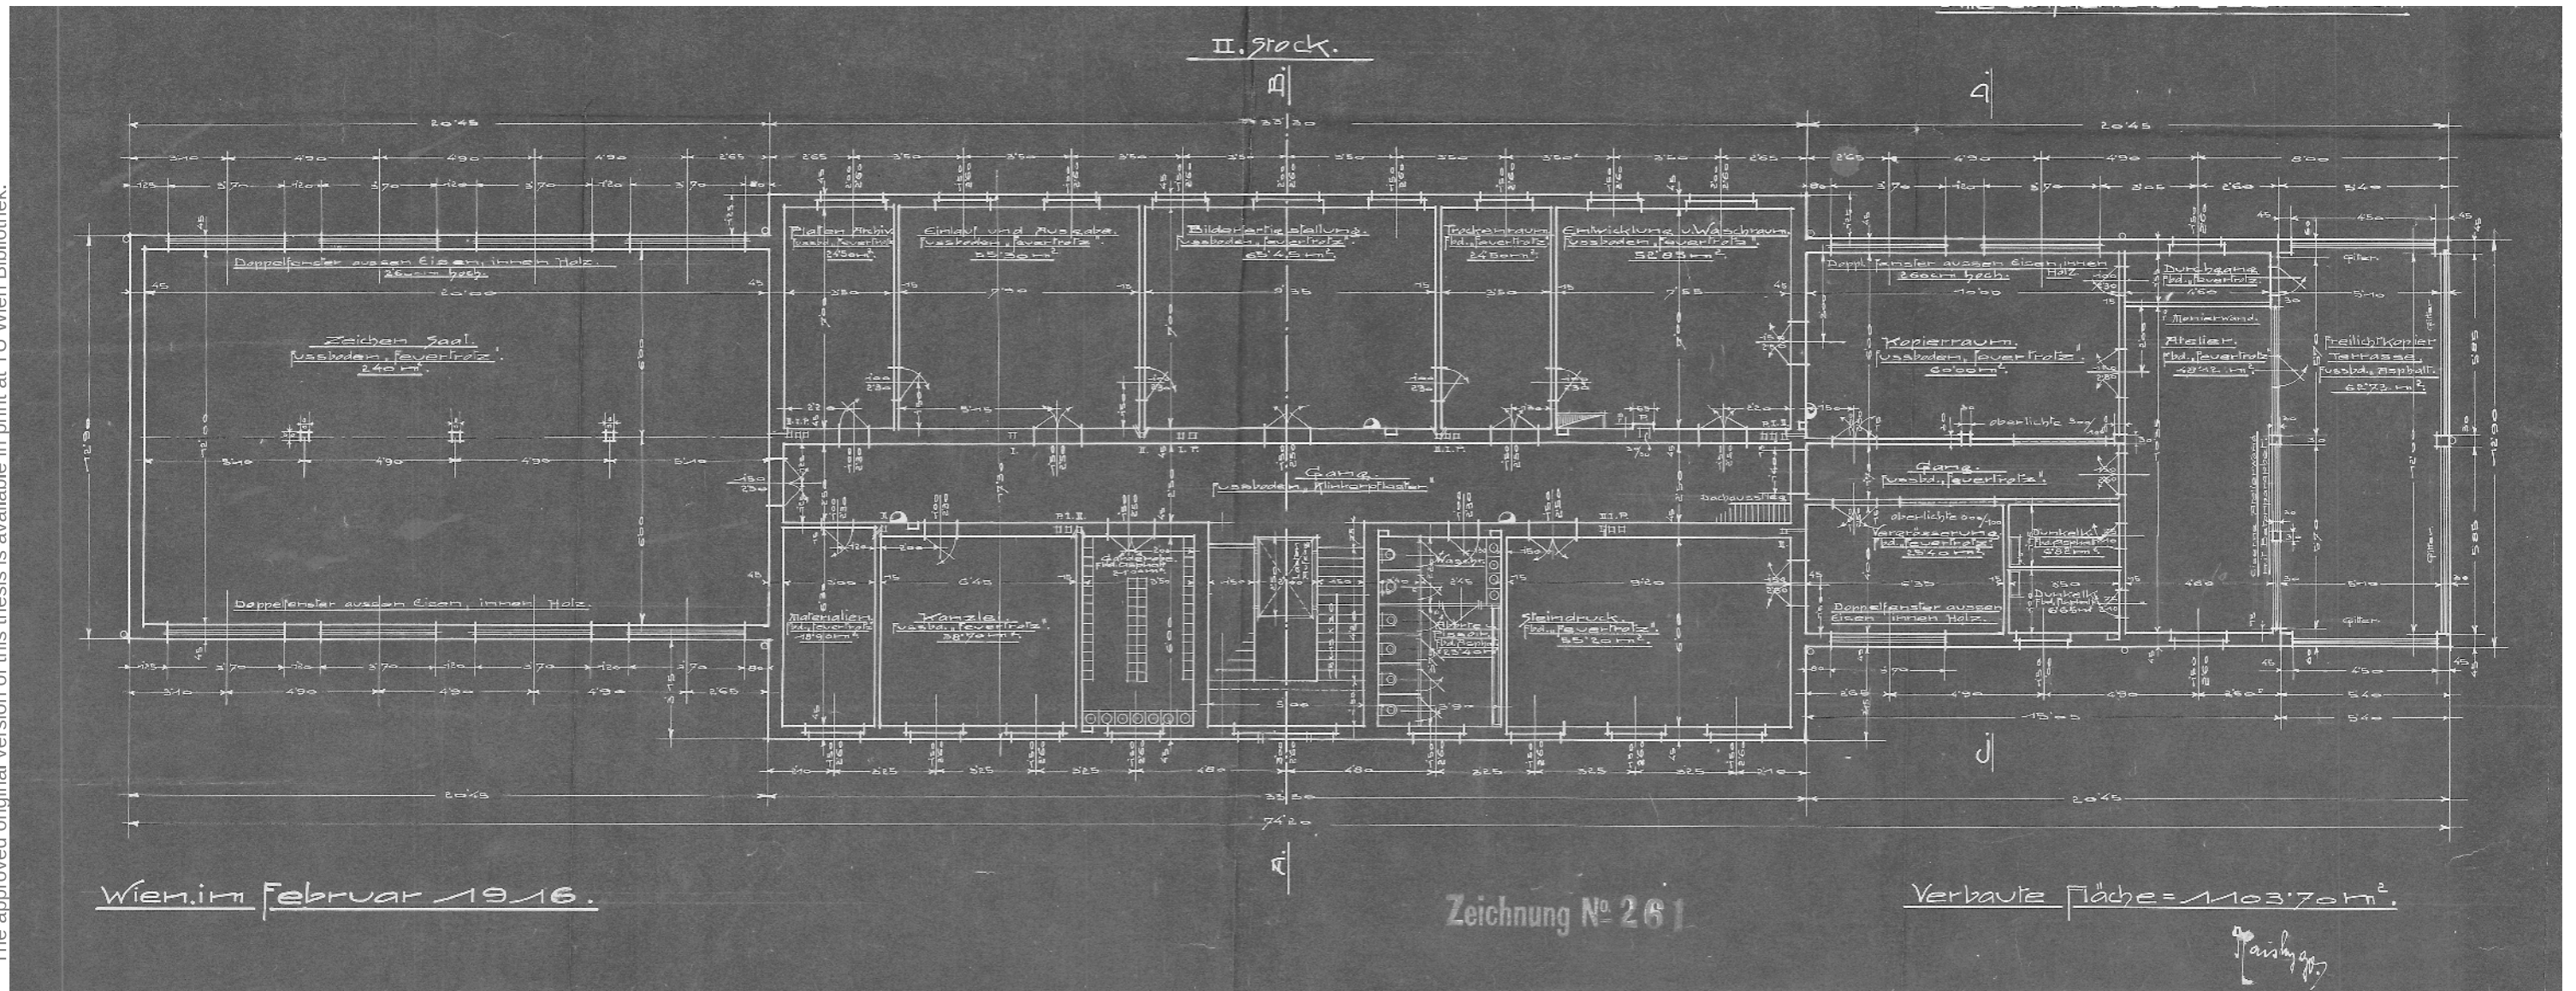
Originalplan Werksgebäude Nr. 210 Grundriss DG, Februar 1916
